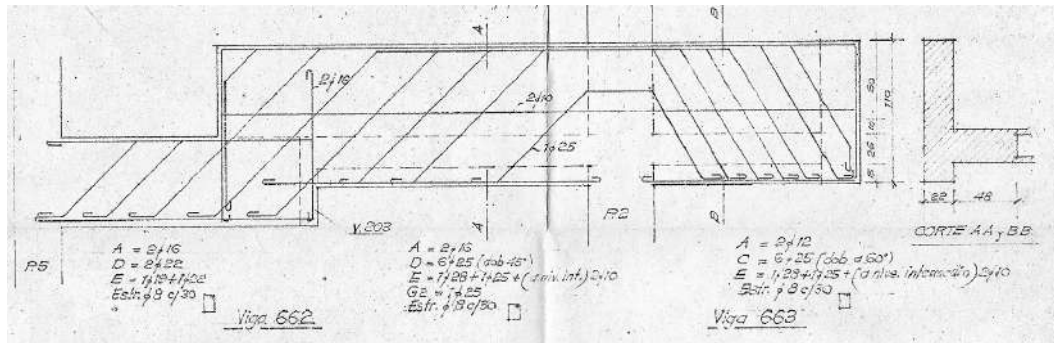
Extracto del proyecto ejecutivo de estructuras del BCLA con el detalle de vigas 662 y 663.
